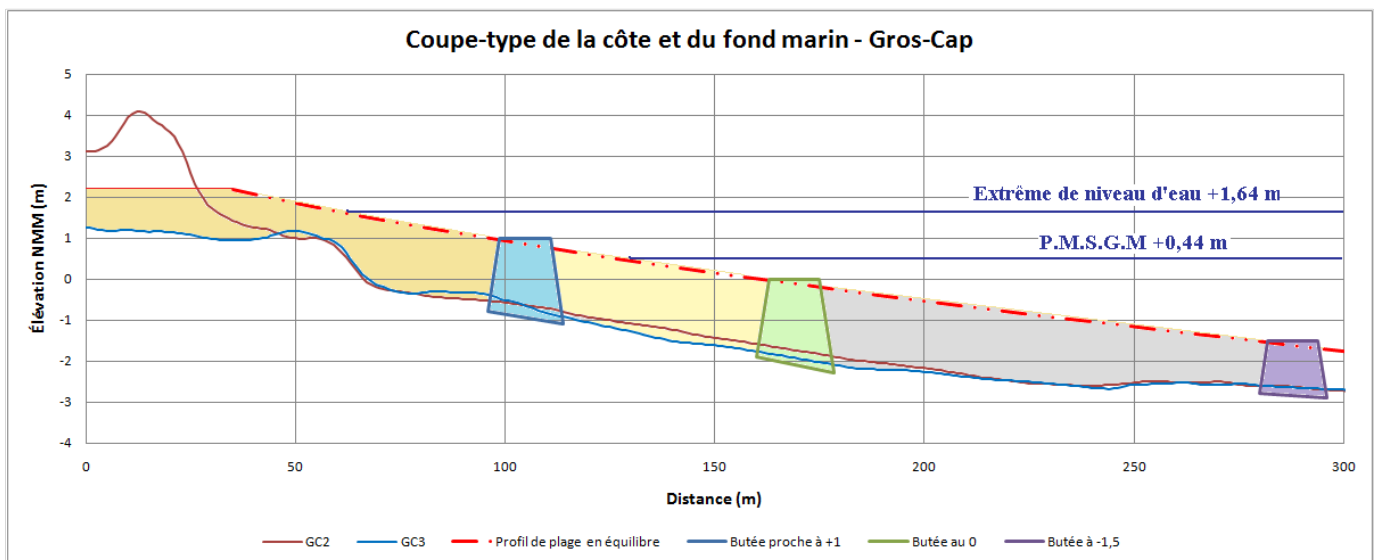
Coupe type d'une plage suspendue devant la plage de la Garderie
